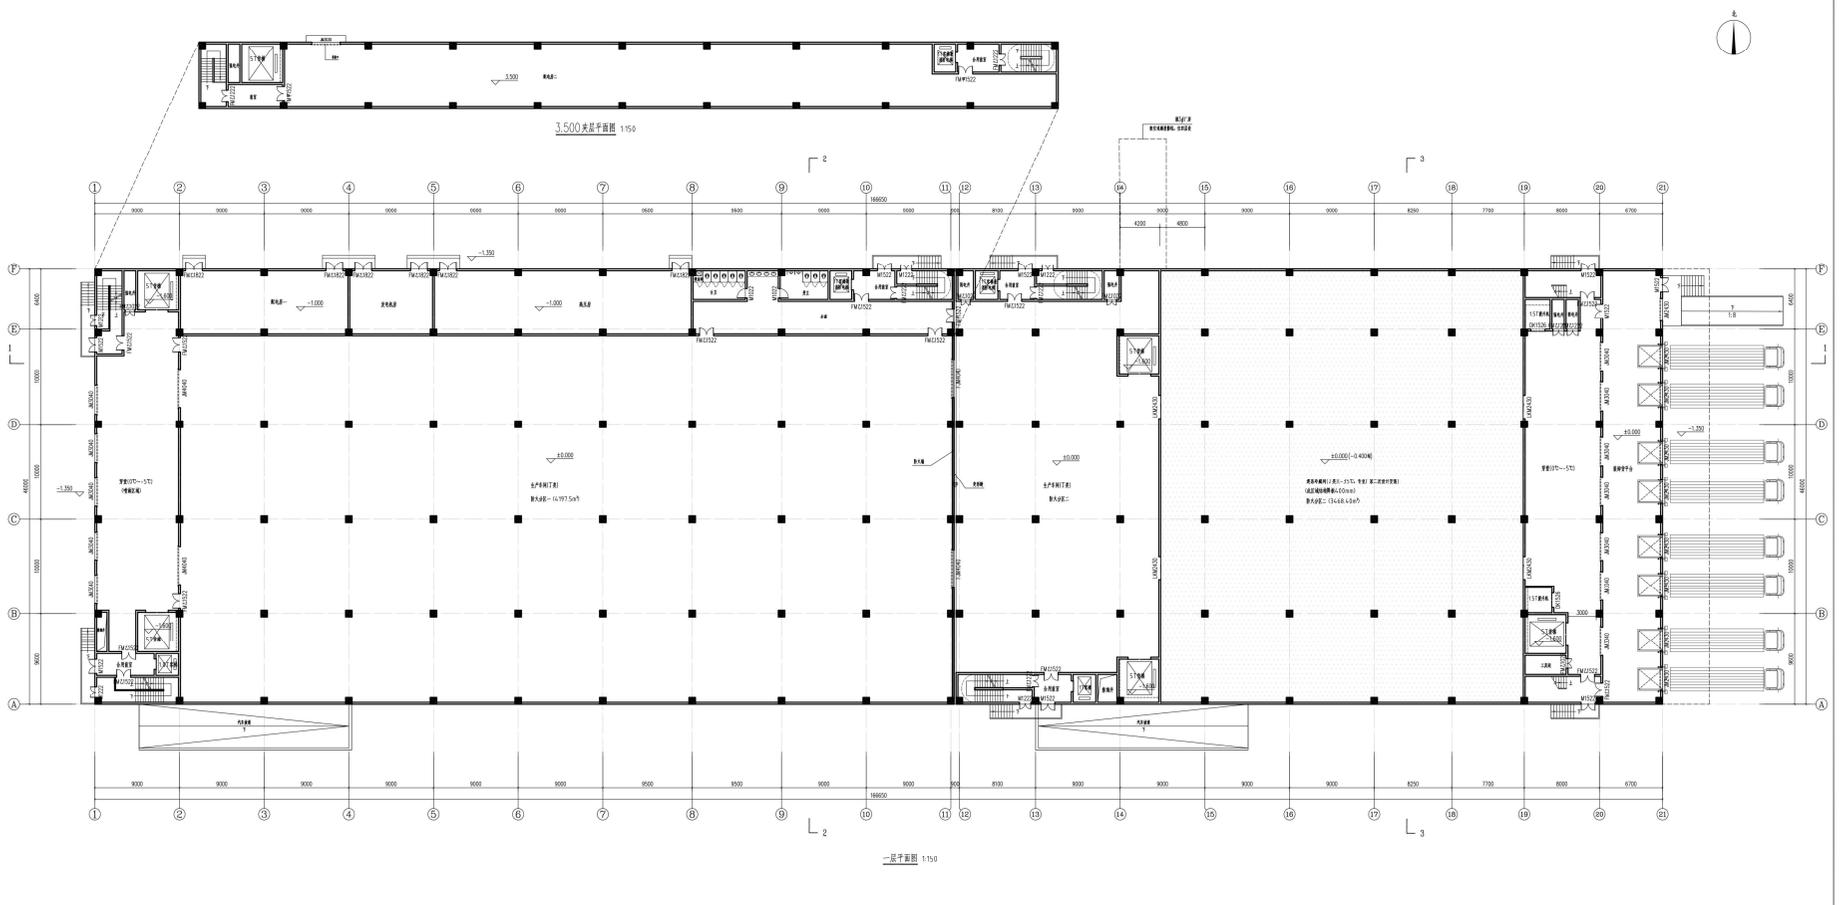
1#厂房一层及 2#厂房一层平面布置图
